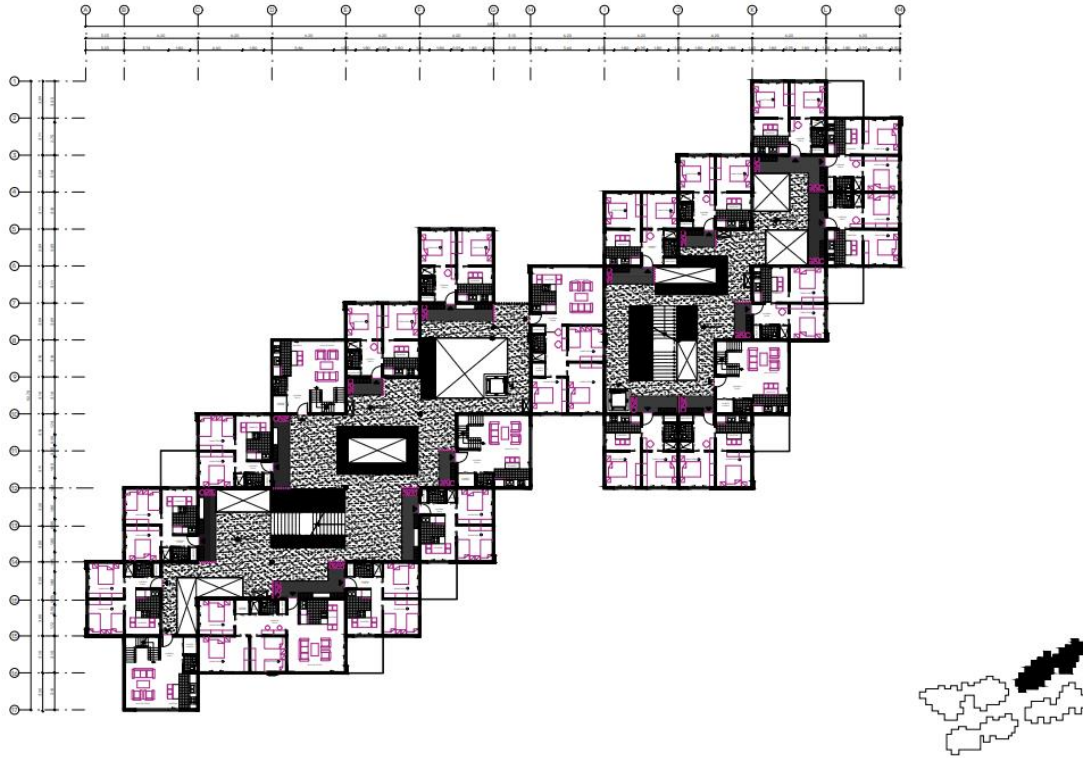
Planta nivel 2 Bloque 3. Elaboración propia 2023
